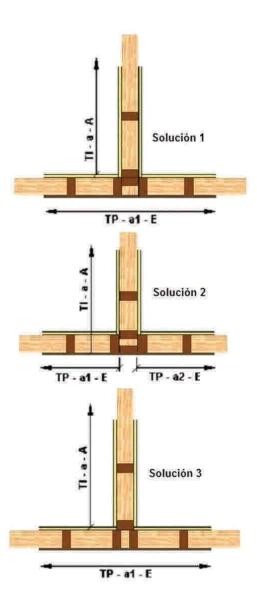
62: Vista en planta para el encuentro entre muros y tabiques unidos en "T".
